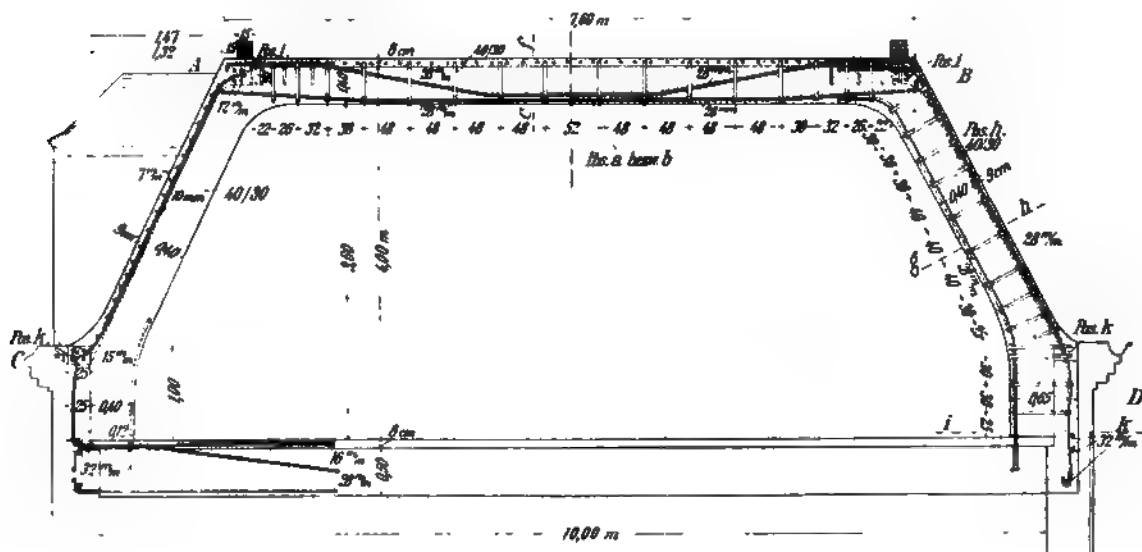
Querschnitt des Trapezdaches (siehe Abb. 300).
